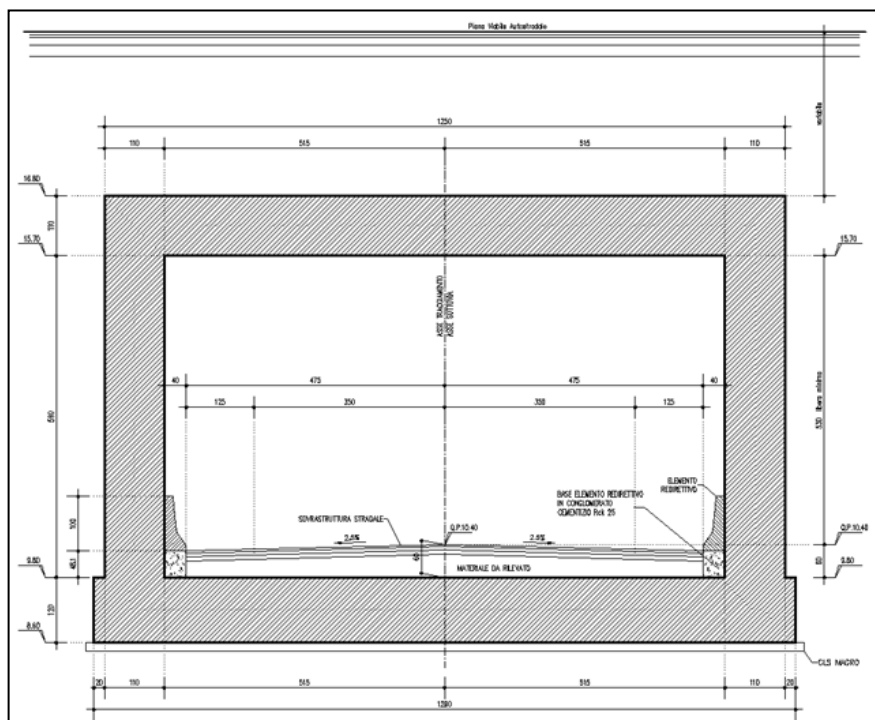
SEZIONE TRASVERSALE DEL SOTTOVIA
